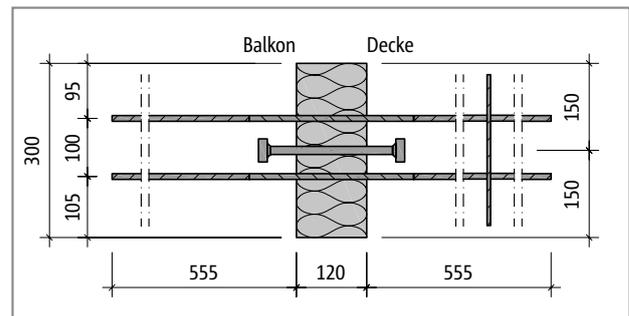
Schöck Isokorb® Typ QPXT10: Produktgrundriss
